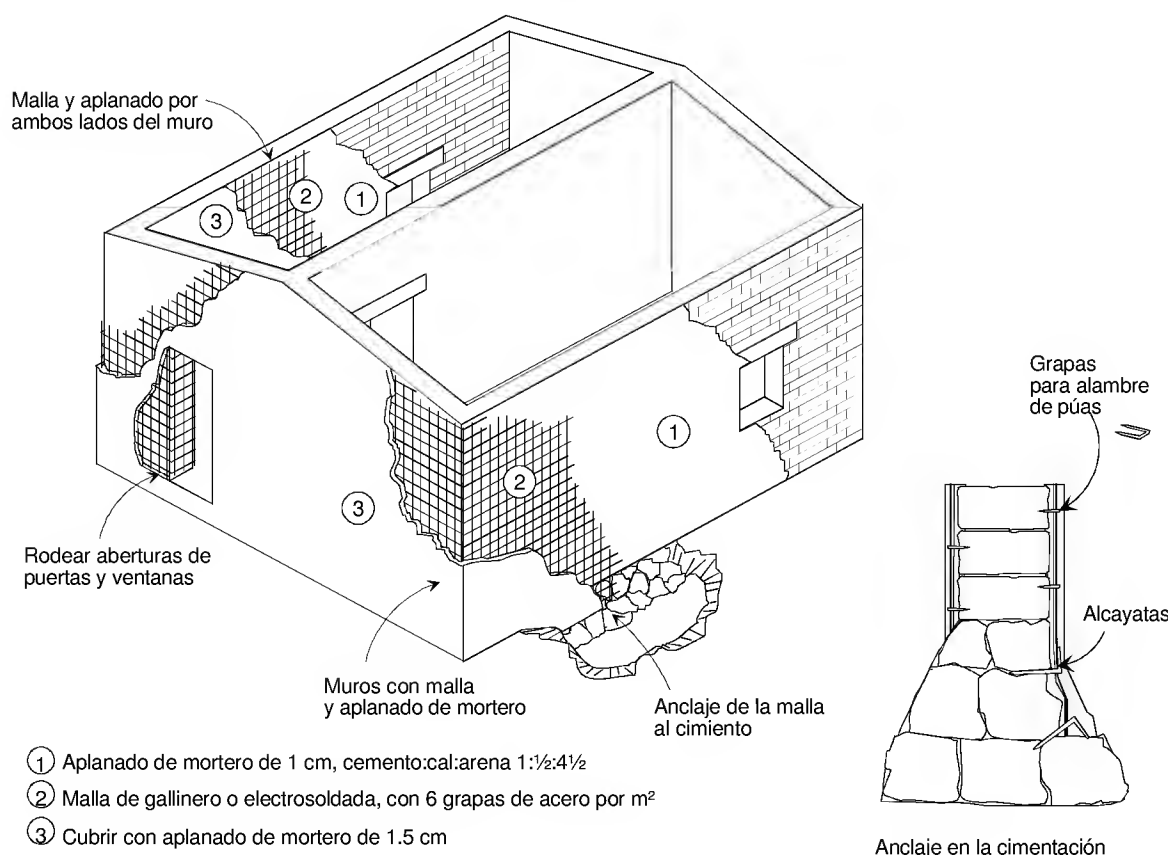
Encamisado de muros de adobe con mallas metálicas recubiertas con mortero
